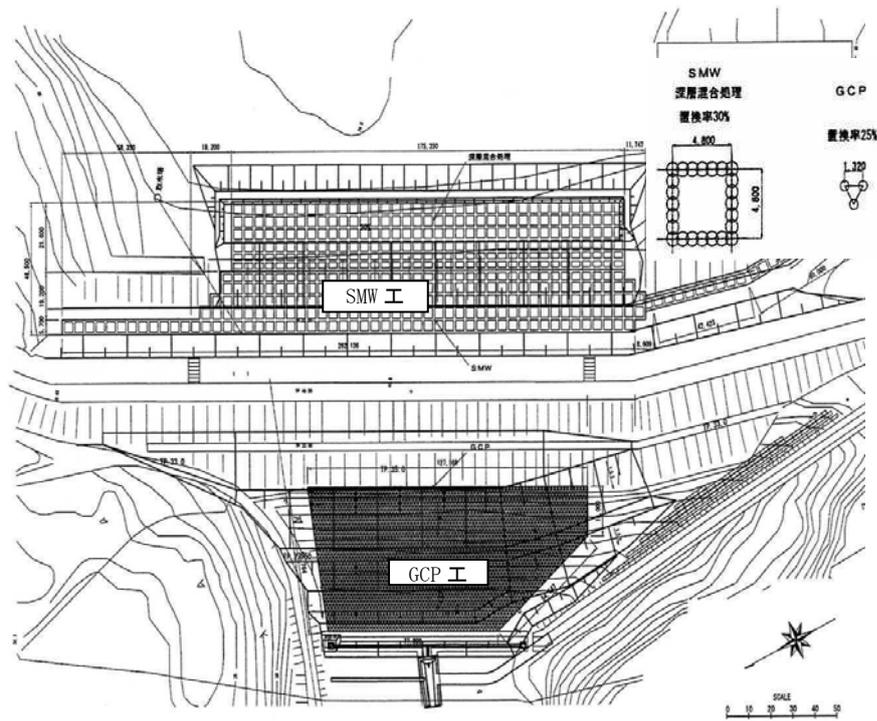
第1堰堤改修計画平面図⁴⁾
